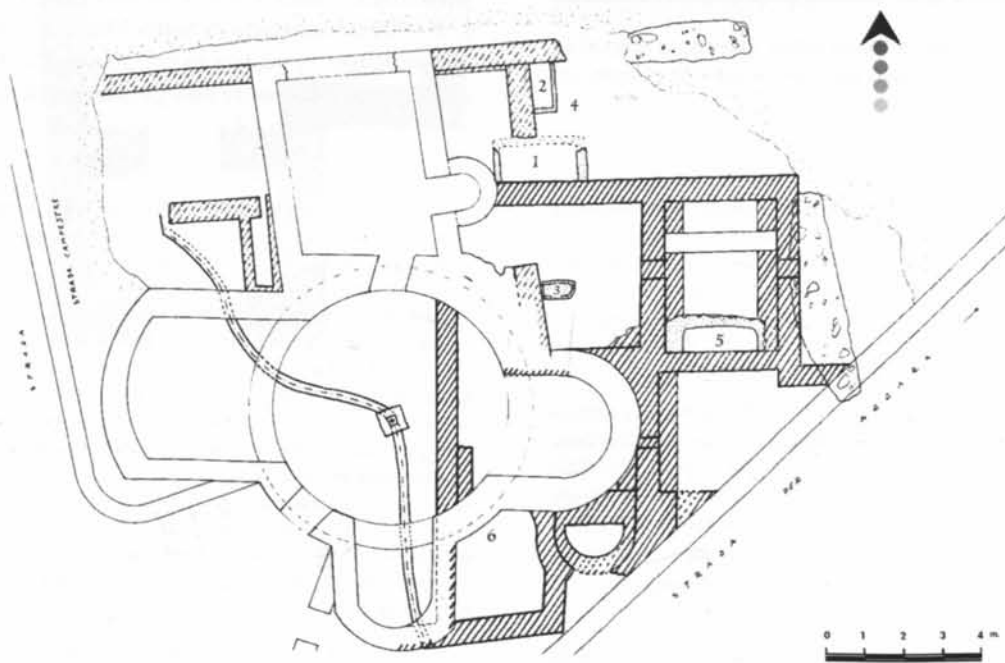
Siligo. Santa Maria di Mesumundu: planimetria (rielaborazione da MAETZKE 1965a).
